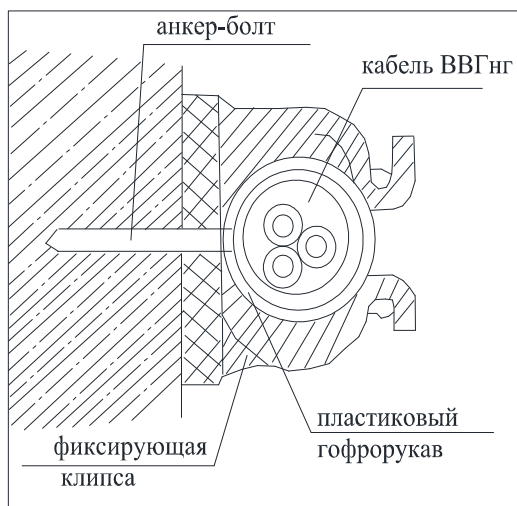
Схема крепления кабеля к стене или перекрытию с помощью нейлоновой стяжки или скобы при разводке кабеля по помещению.
